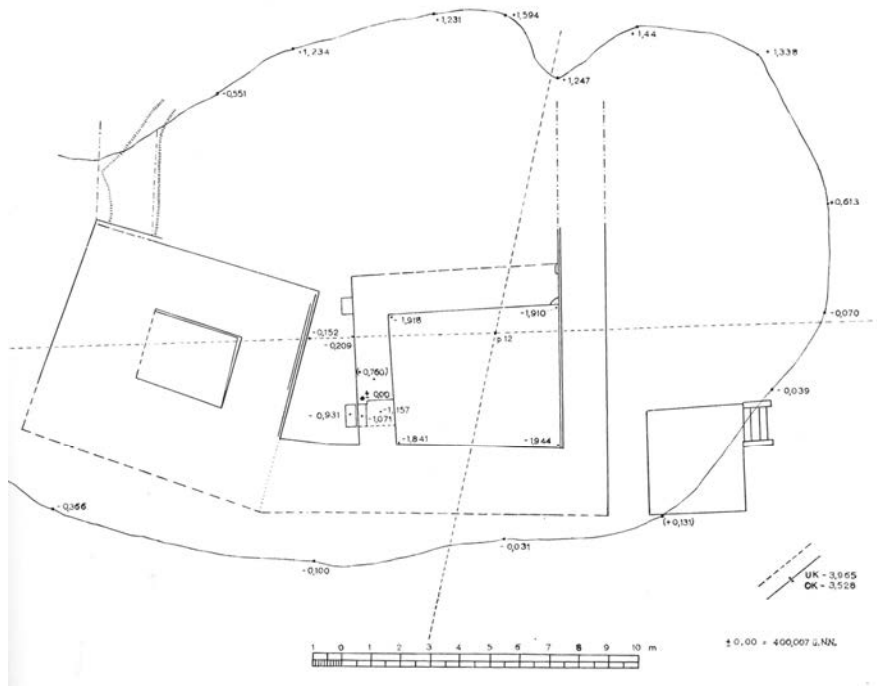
Burg Dischingen, Grundriss, M 1:200, 04/1952
